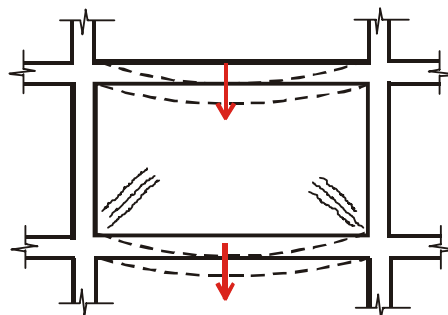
fissuras em parede de vedação por deformação das vigas de apoio e superior (DUARTE, 1998)
